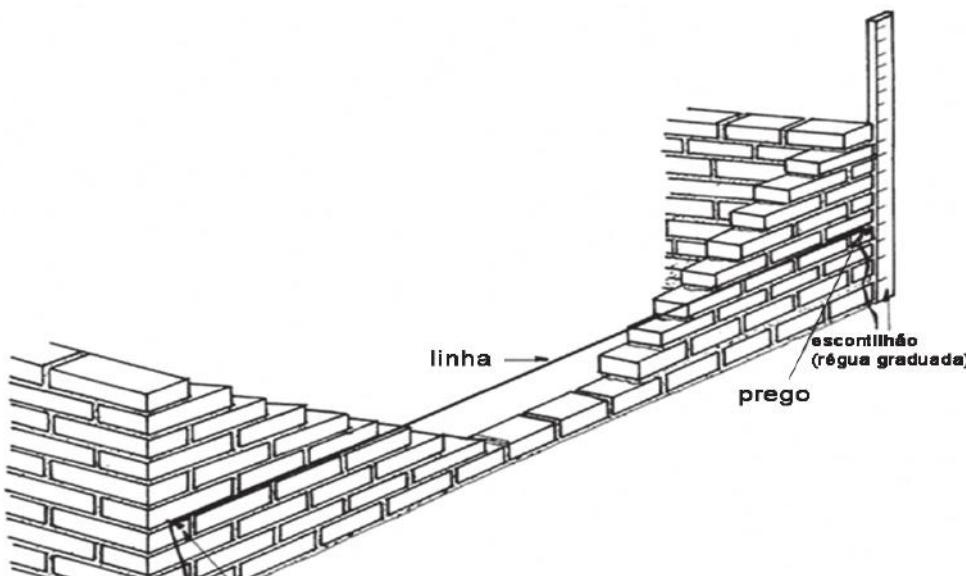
Detalhe do nivelamento da elevação da alvenaria
